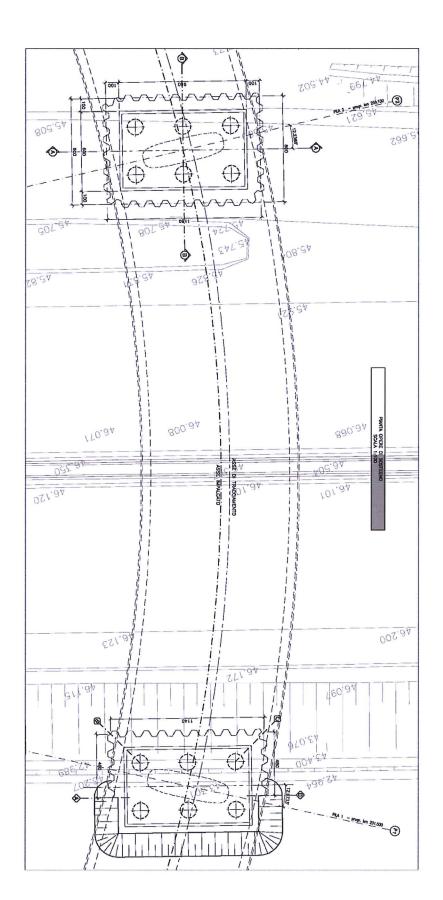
PIANTA DELLE OPERE DI SOSTEGNO
